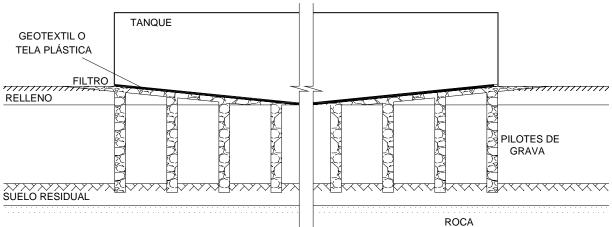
Drenaje Vertical con Pilotes de Grava
